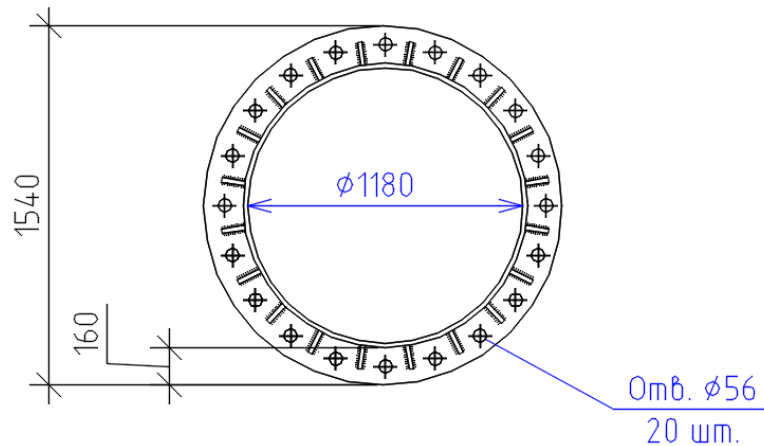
Фланец для соединения элементов нижнего пояса фермы
